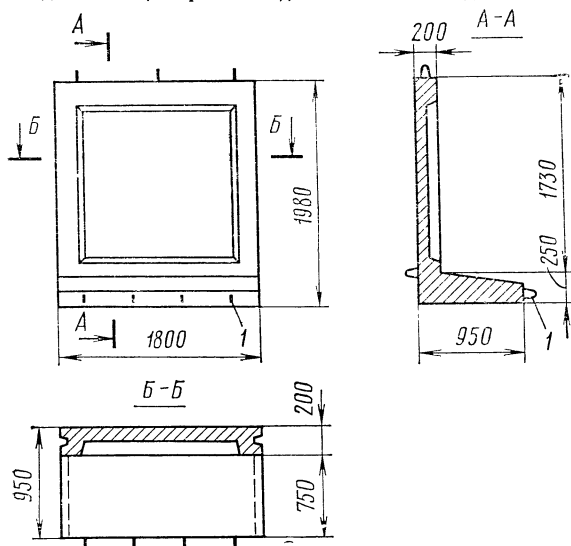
Железобетонный стеновой блок СТ-1:
